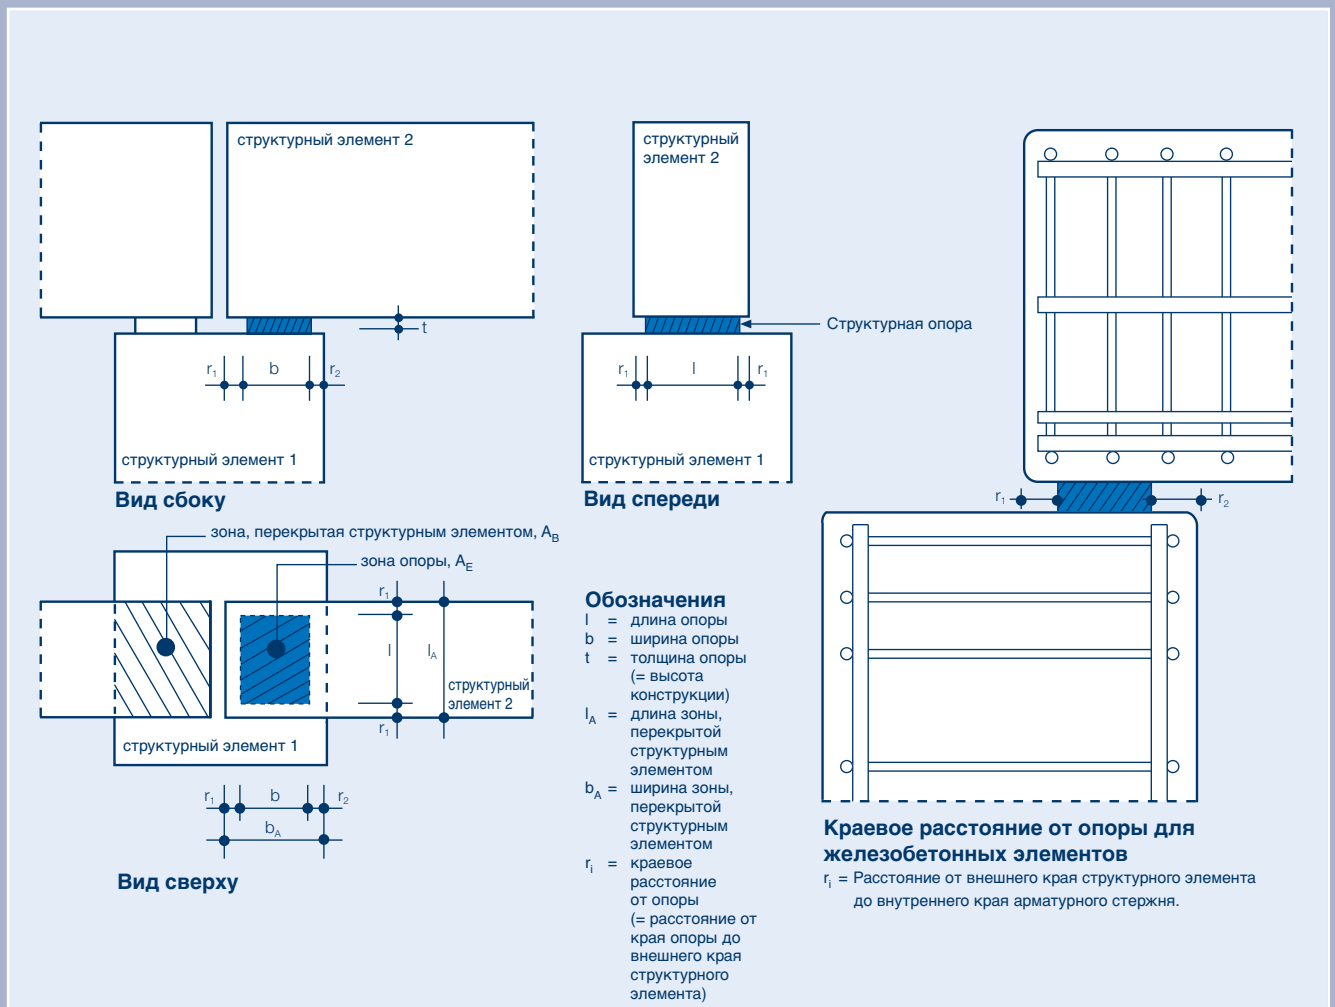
Максимальный размер площади эластомерной опоры в плане для железобетонных конструкций (краевое расстояние). Для деревянных или стальных элементов расстояние от края должно быть как минимум 3 ст или 1,5 толщины опоры.
